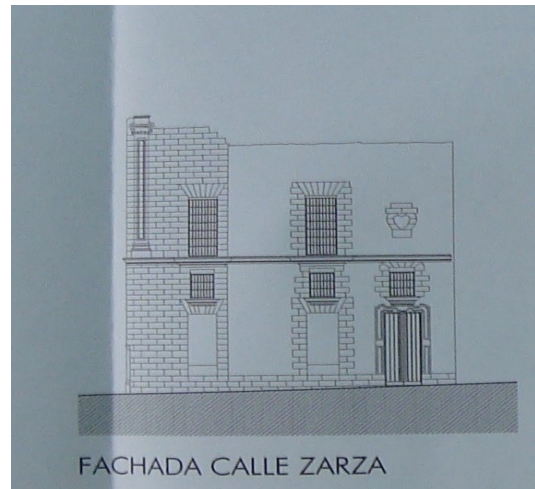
Alzado de la fachada correspondiente a calle Zarza, (NAVARRO, 2009)
